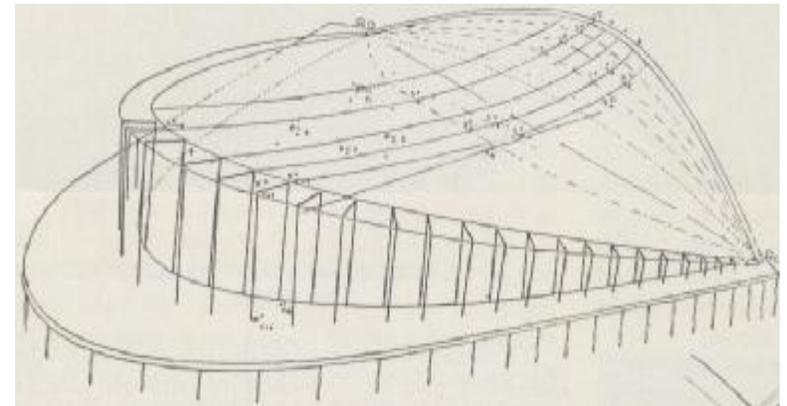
Dos arcos parecido a las parábola se sitúan en planos inclinados sobre pórticos que sirven de apoyo y dan rigidez.²⁵
